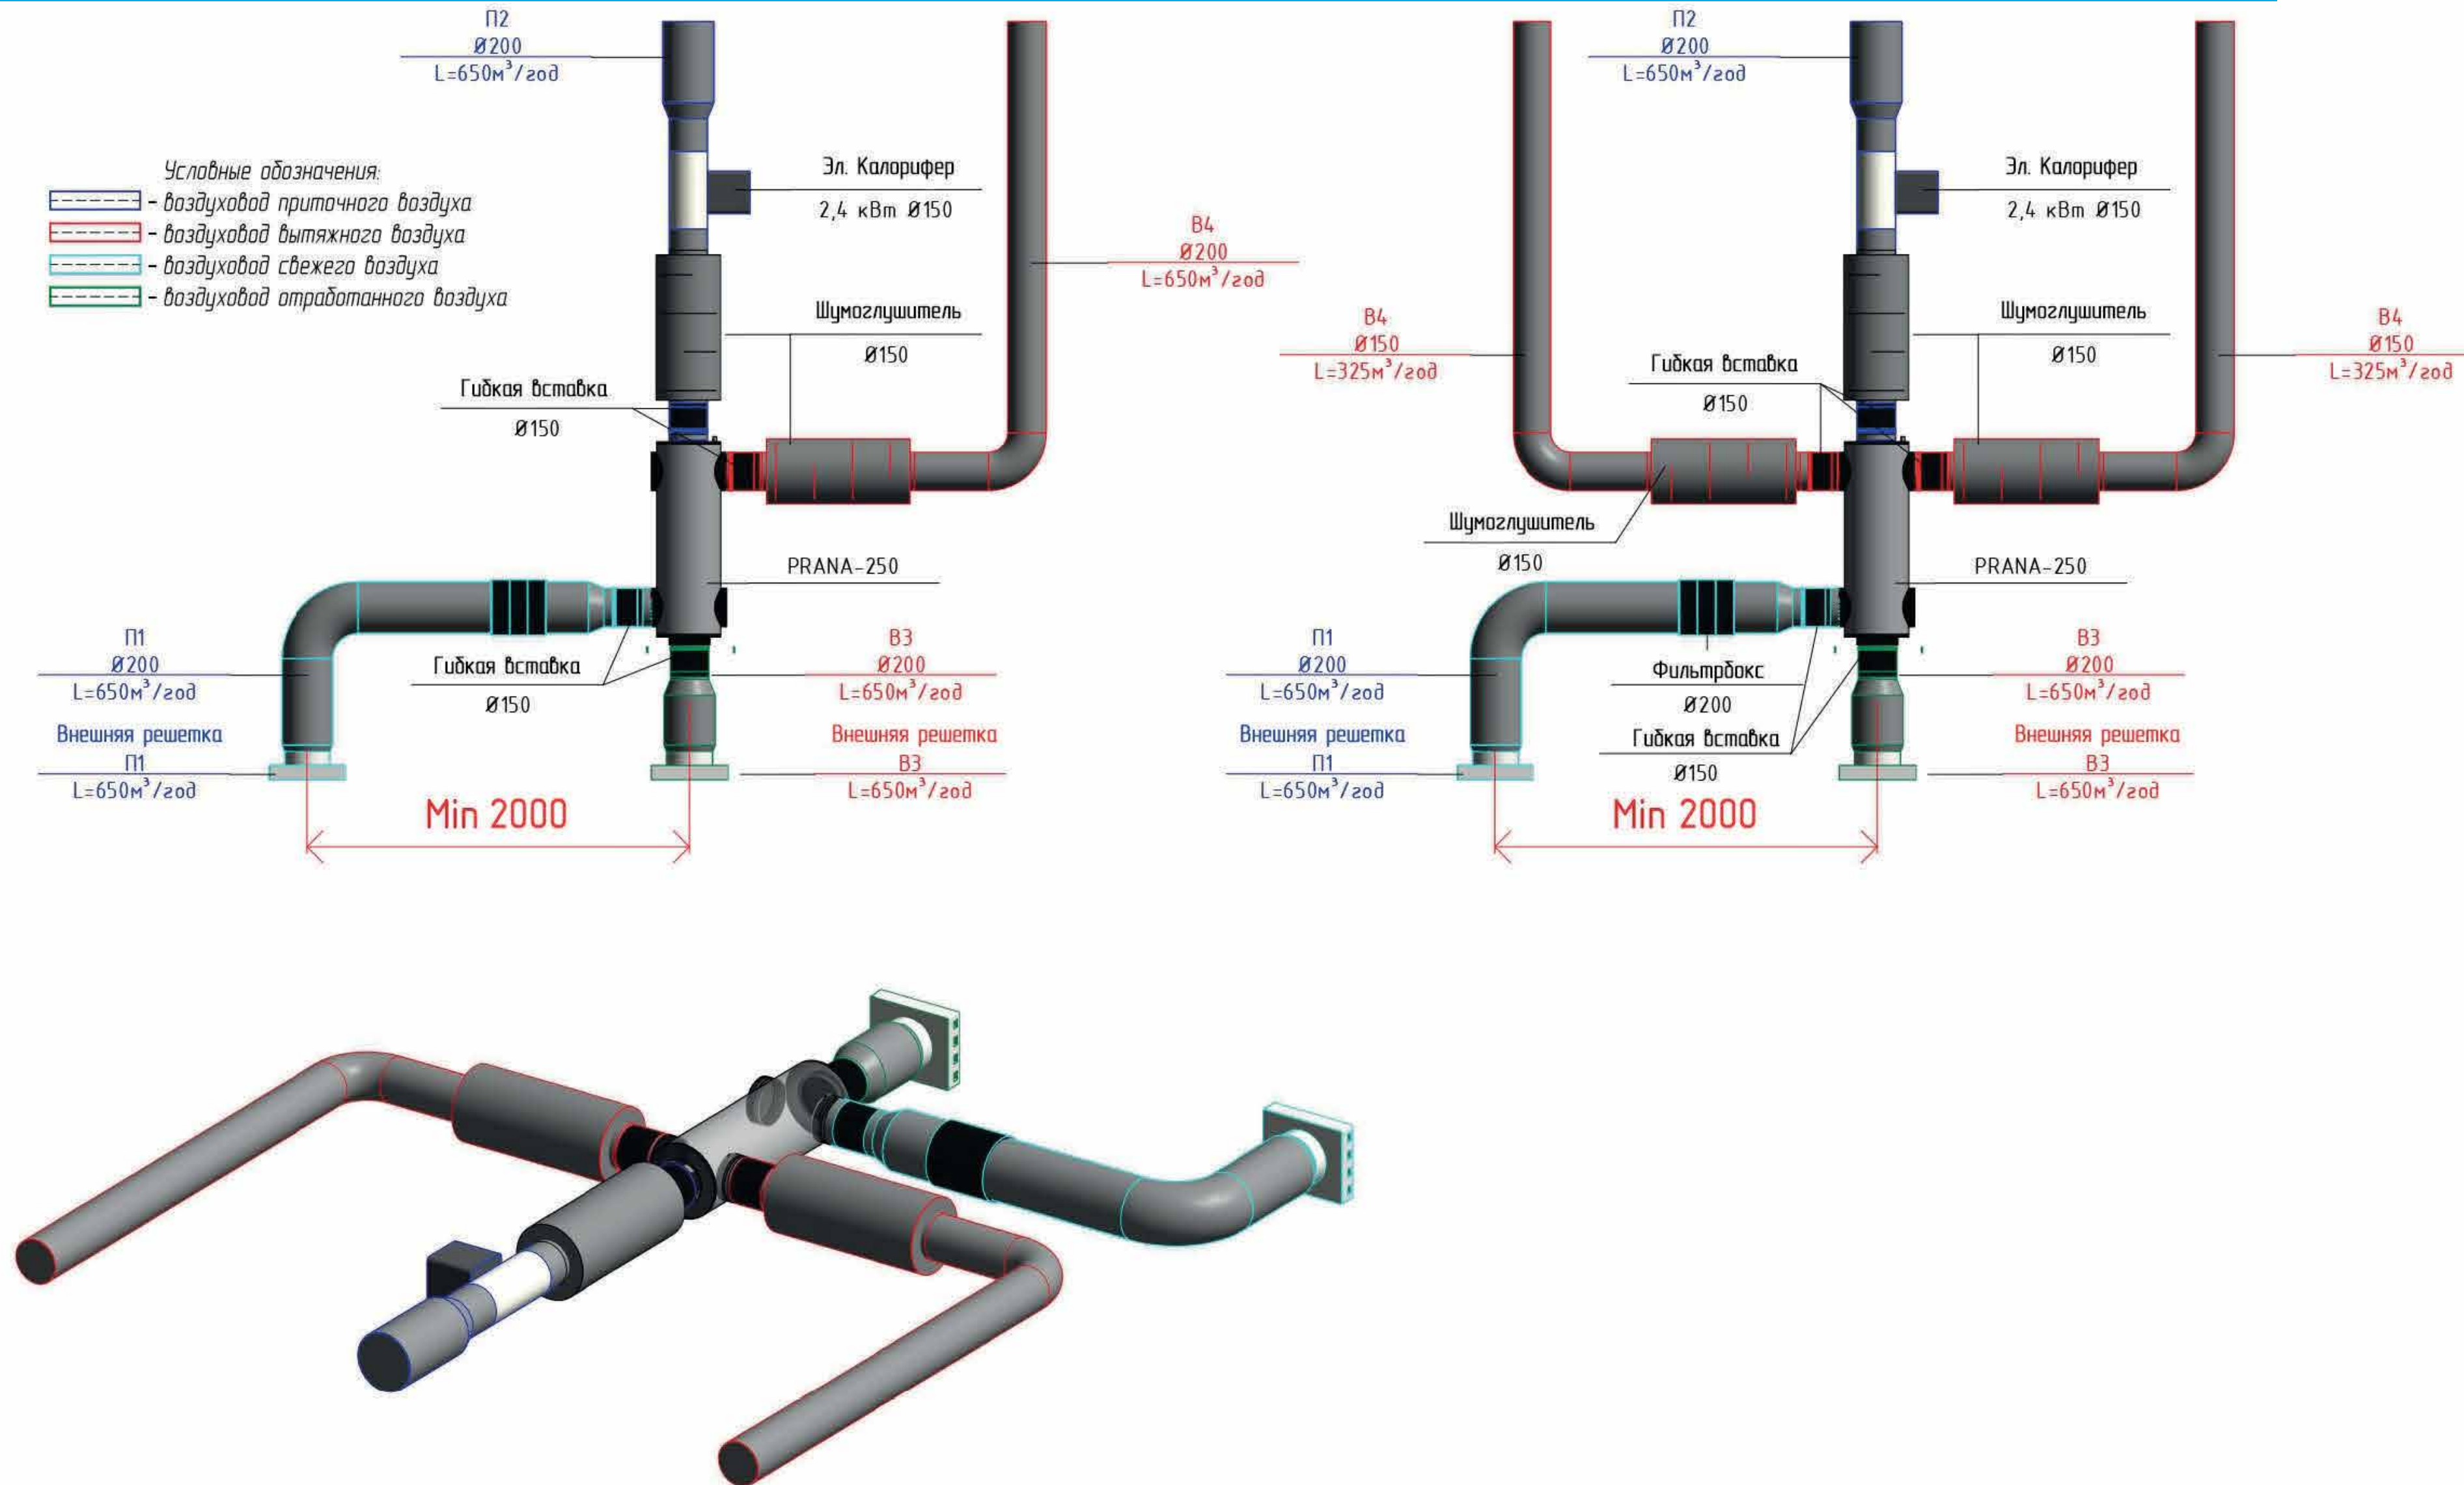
Вид сверху. Канальная система вентиляции PRANA-250 №1 расположена в помещении под потолком с подключением дополнительных элементов
